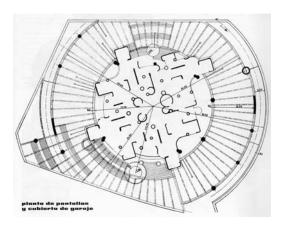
Planta baja. Pantallas y cubierta del garaje. (Estructura 1970)
